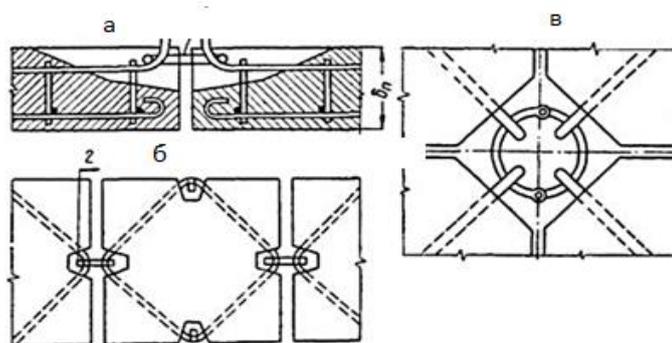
Шарнирное соединение сборных железобетонных плит: а и б - посередине сторон плит; в - по углам плит; 1 - шарнирный хомут; 2 - отверстия, заливаемые асфальтом
